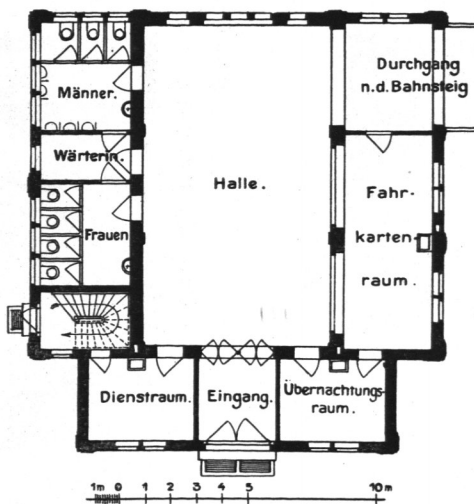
Haltestelle Rübenkamp, Grundriß des Erdgeschosses.
